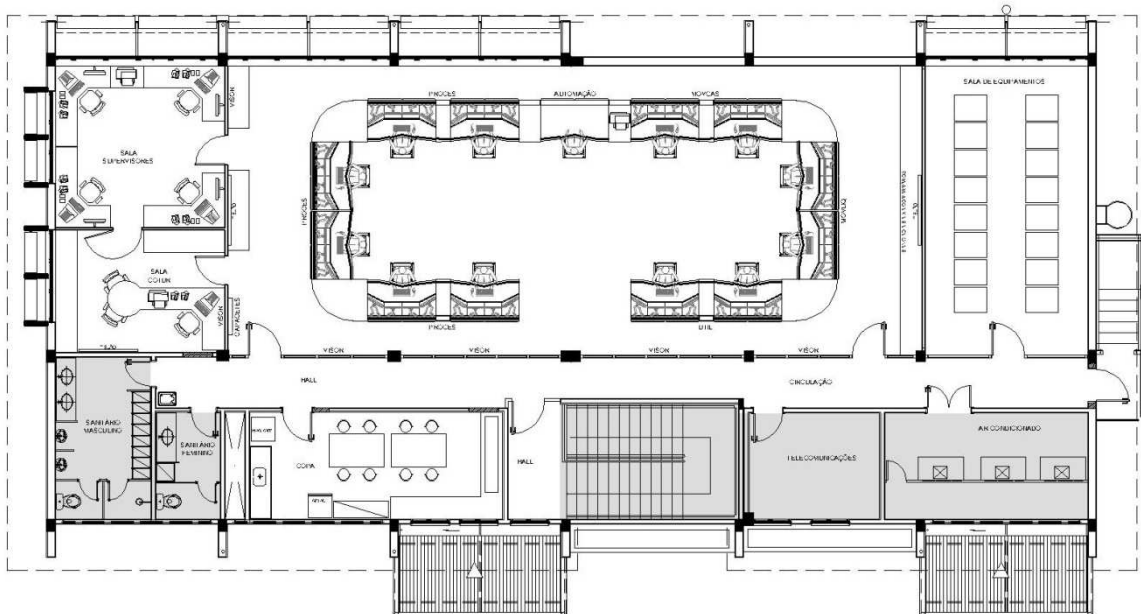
Planta baixa com a opção de *layout* final do primeiro pavimento
